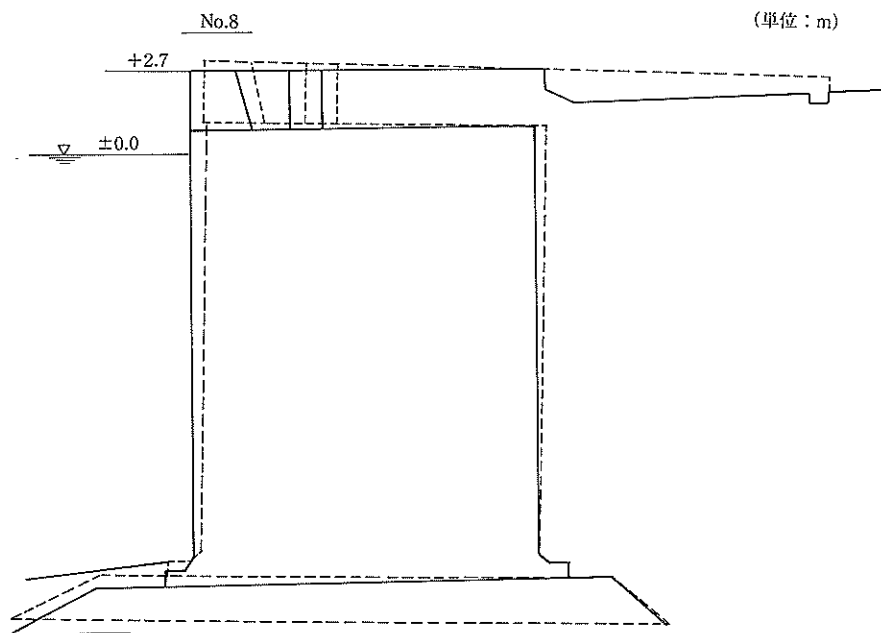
(2) 外港-13m岸壁被災断面図⁸⁾
